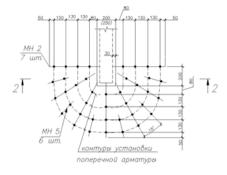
Характер поперечного армирования плиты у торца диафрагмы
